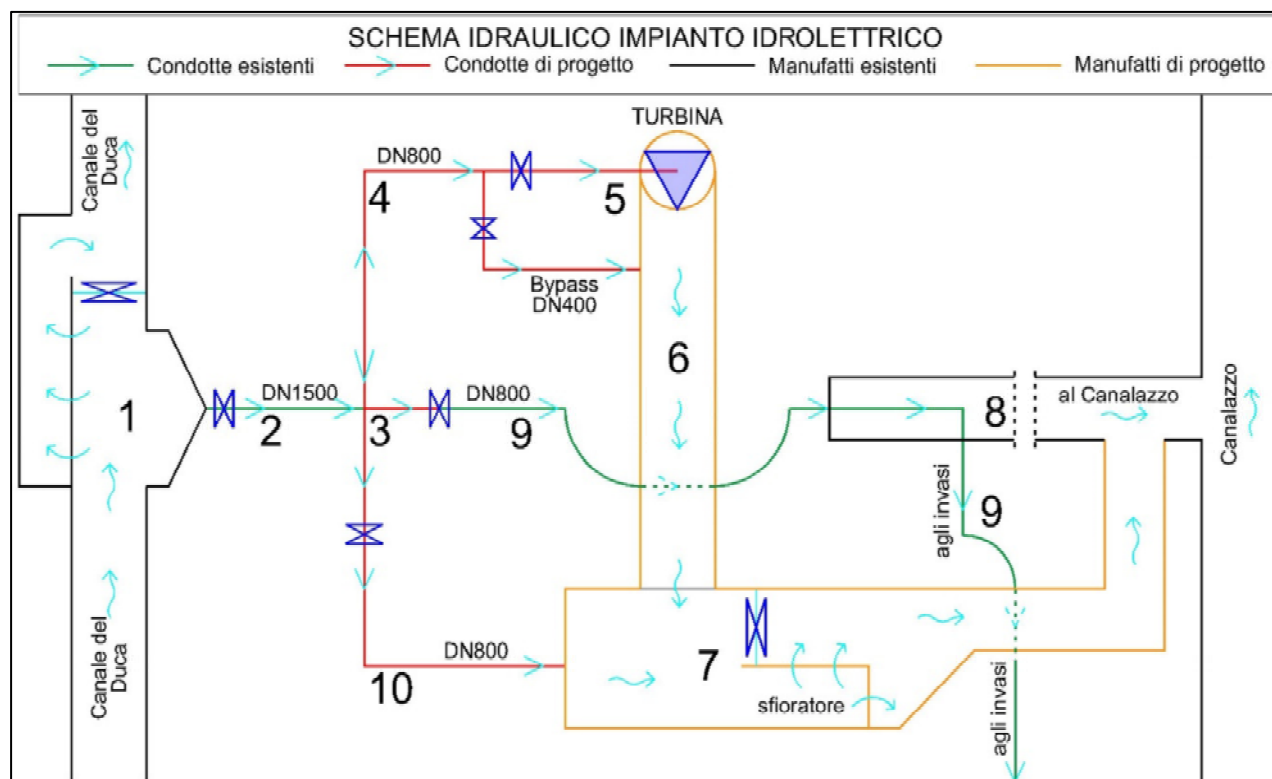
SCHEMA IDRAULICO IMPIANTO IDROELETTRICO
